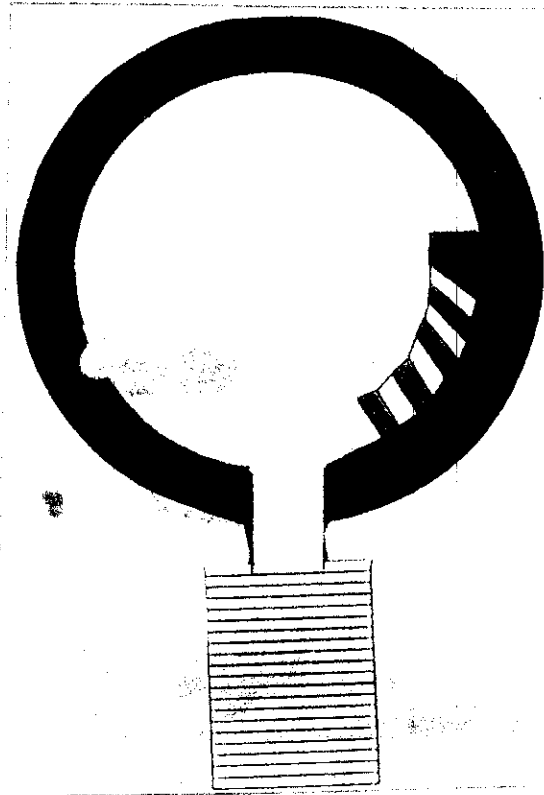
مسقط أفقى لطاحونة الرياح بالمنتزح
